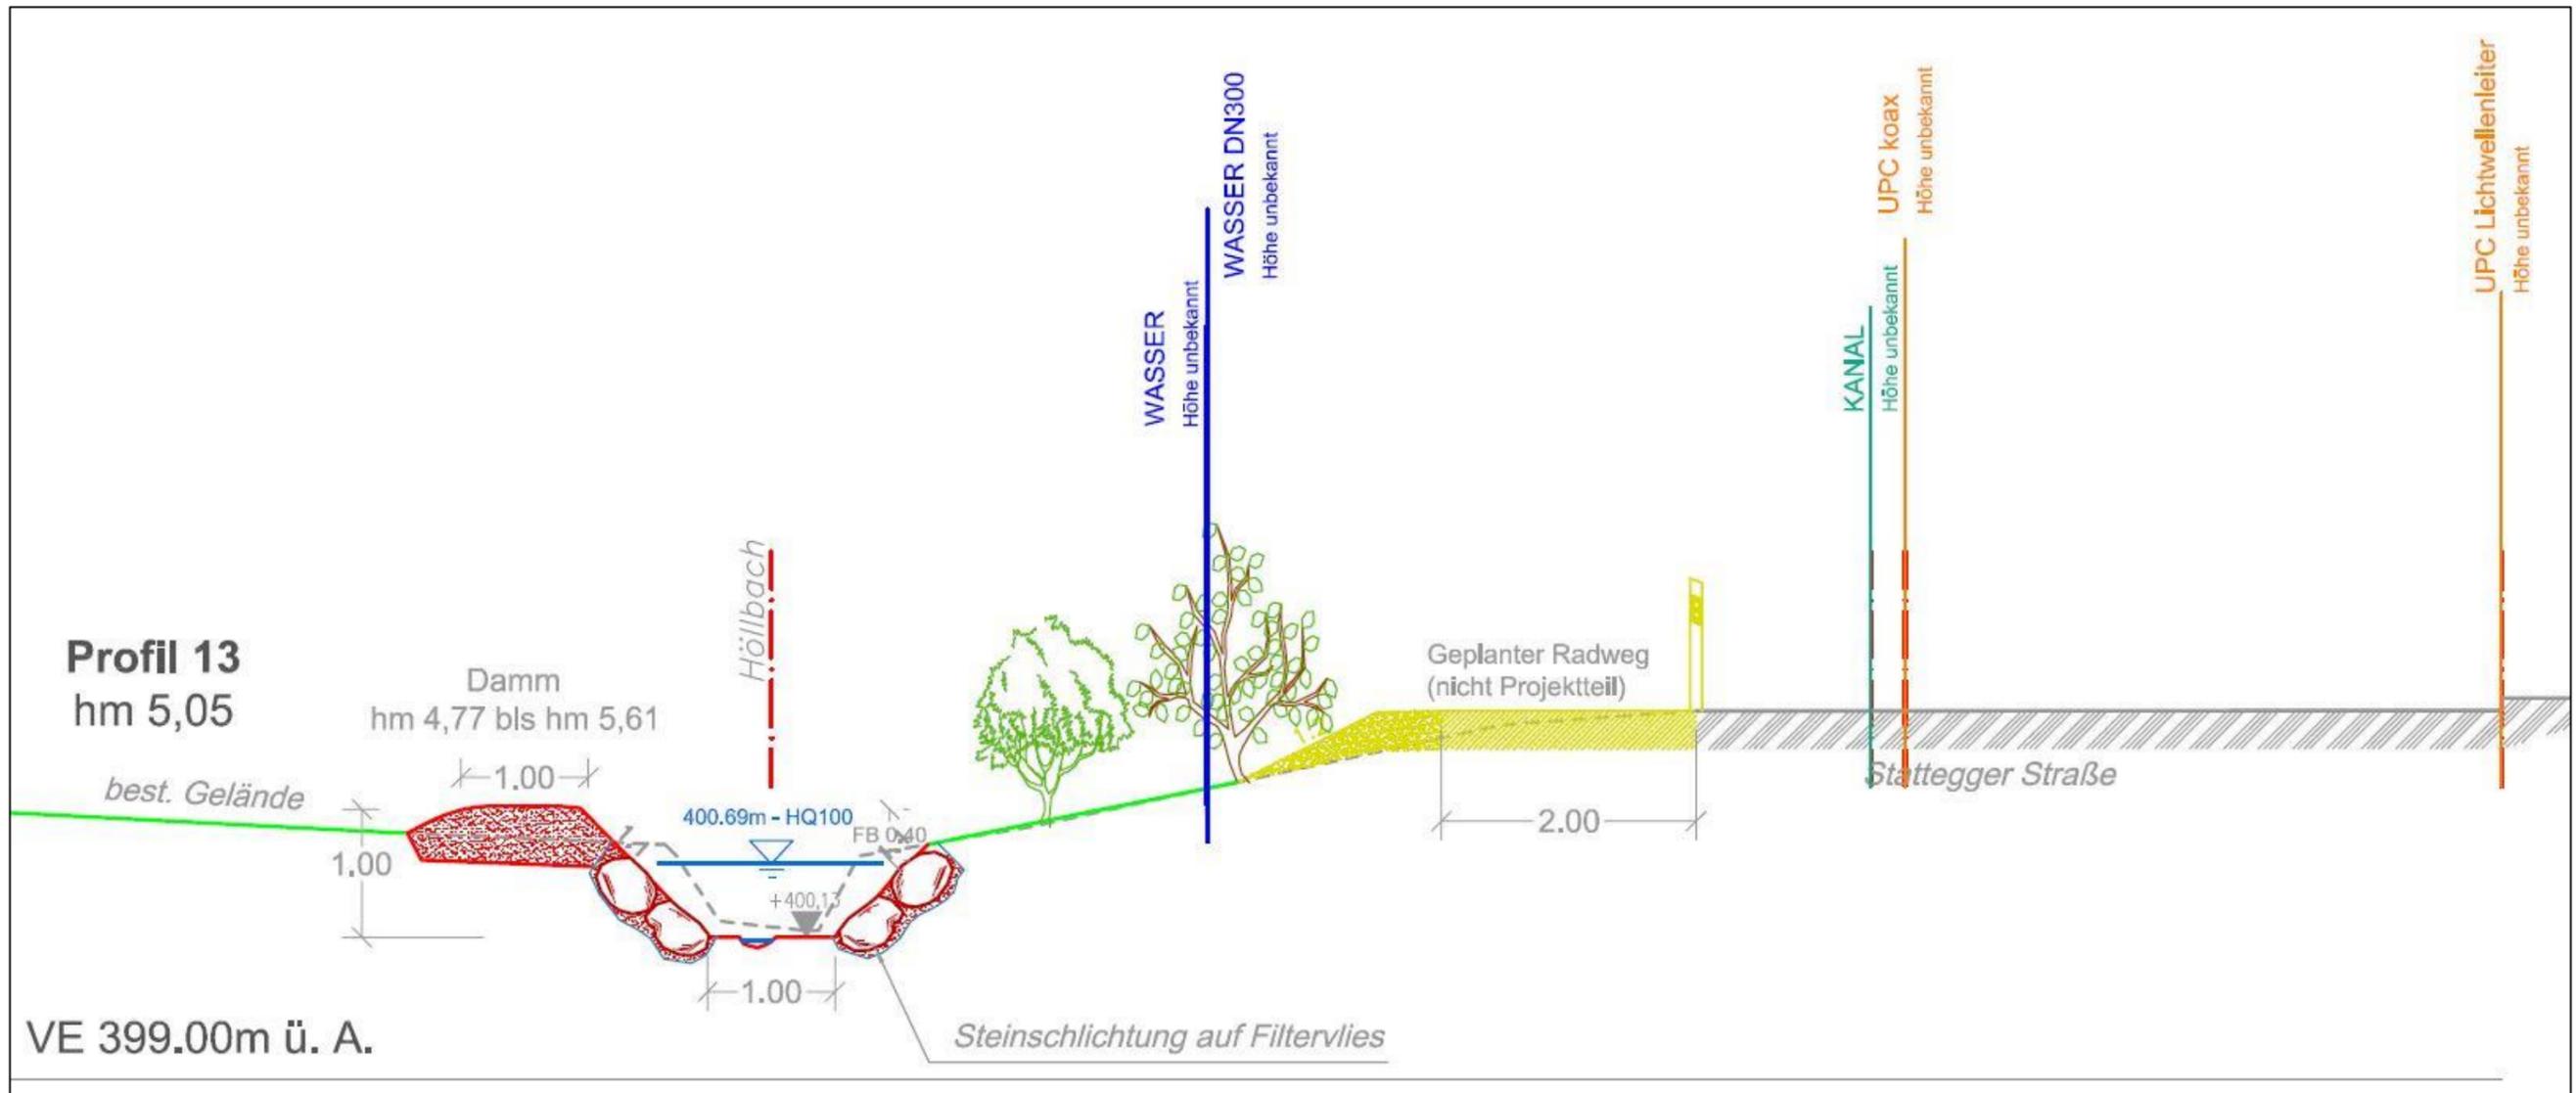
Profil 13 Höllbach (Ausschnitt aus „Schnitt Profil 11-19 Höllbach“) [Q8]
